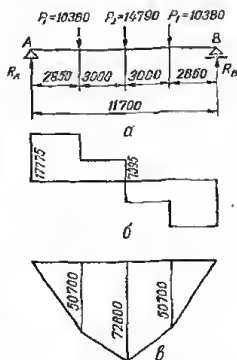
Расчетная схема и эпюры внутренних усилий от расчетных нагрузок:
